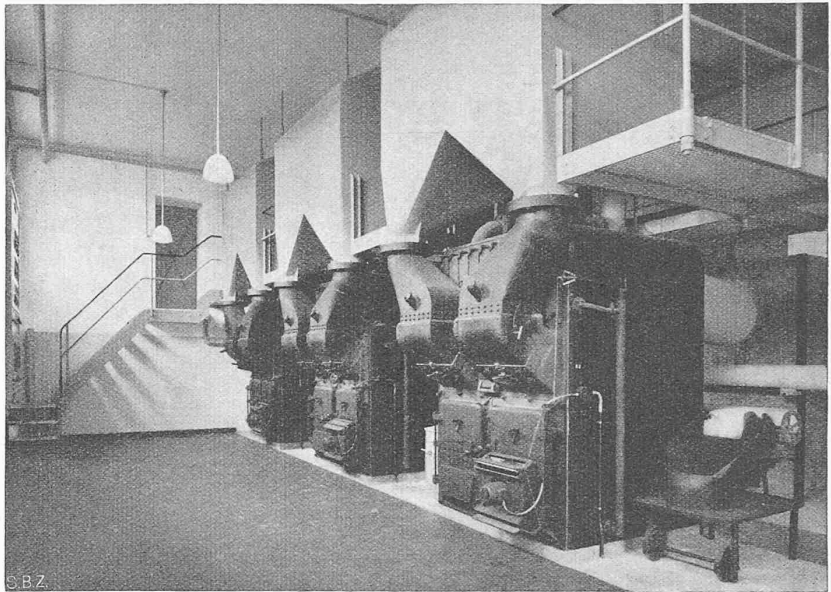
Kesselhaus mit drei Taschenkesseln von je 50 m<sup>2</sup> Heizfläche
